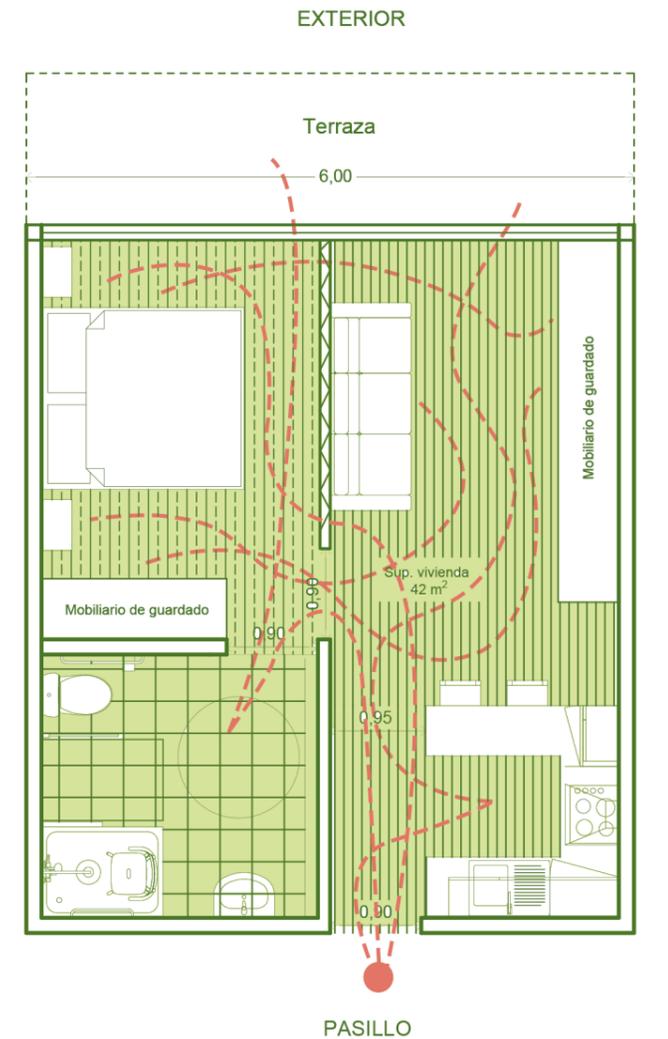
Propuesta de planta para unidad de vivienda unipersonal. Elaboración Propia.
